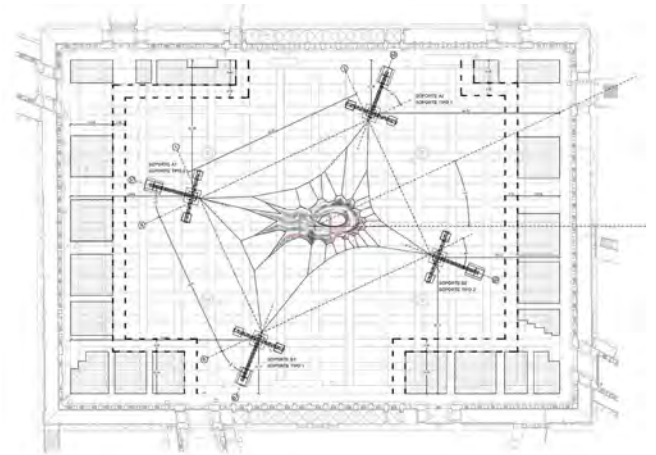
Esquema general en planta de la estructura auxiliar de soporte de la pieza tensada.
